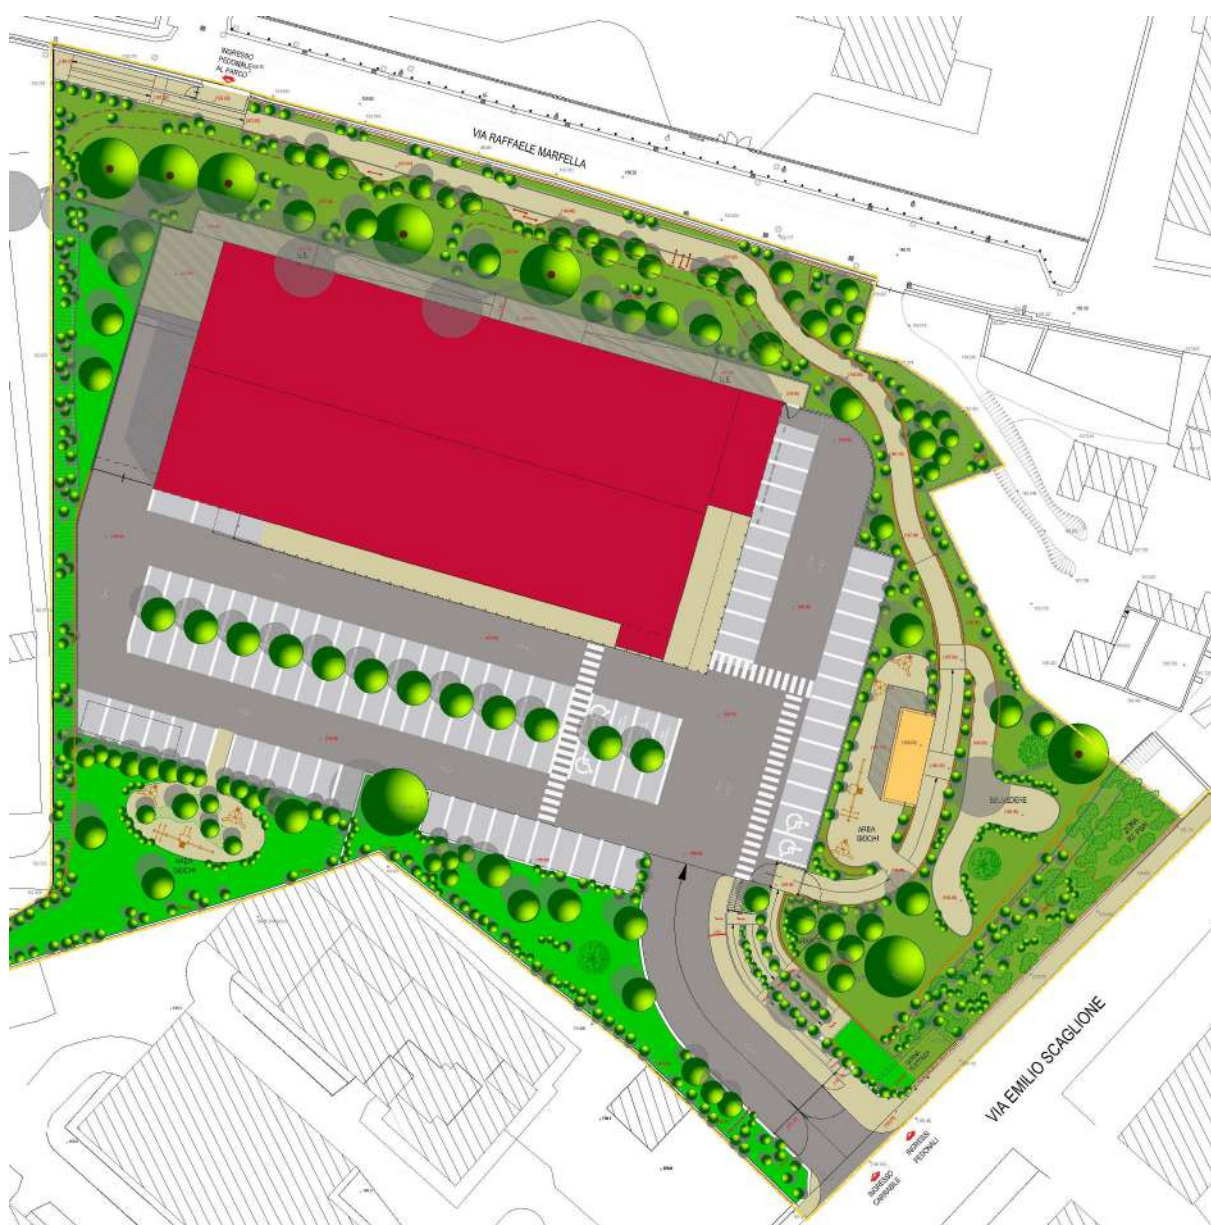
Stralcio planimetrico della dotazione di aree di sosta a servizio dell'area di verde pubblico.
